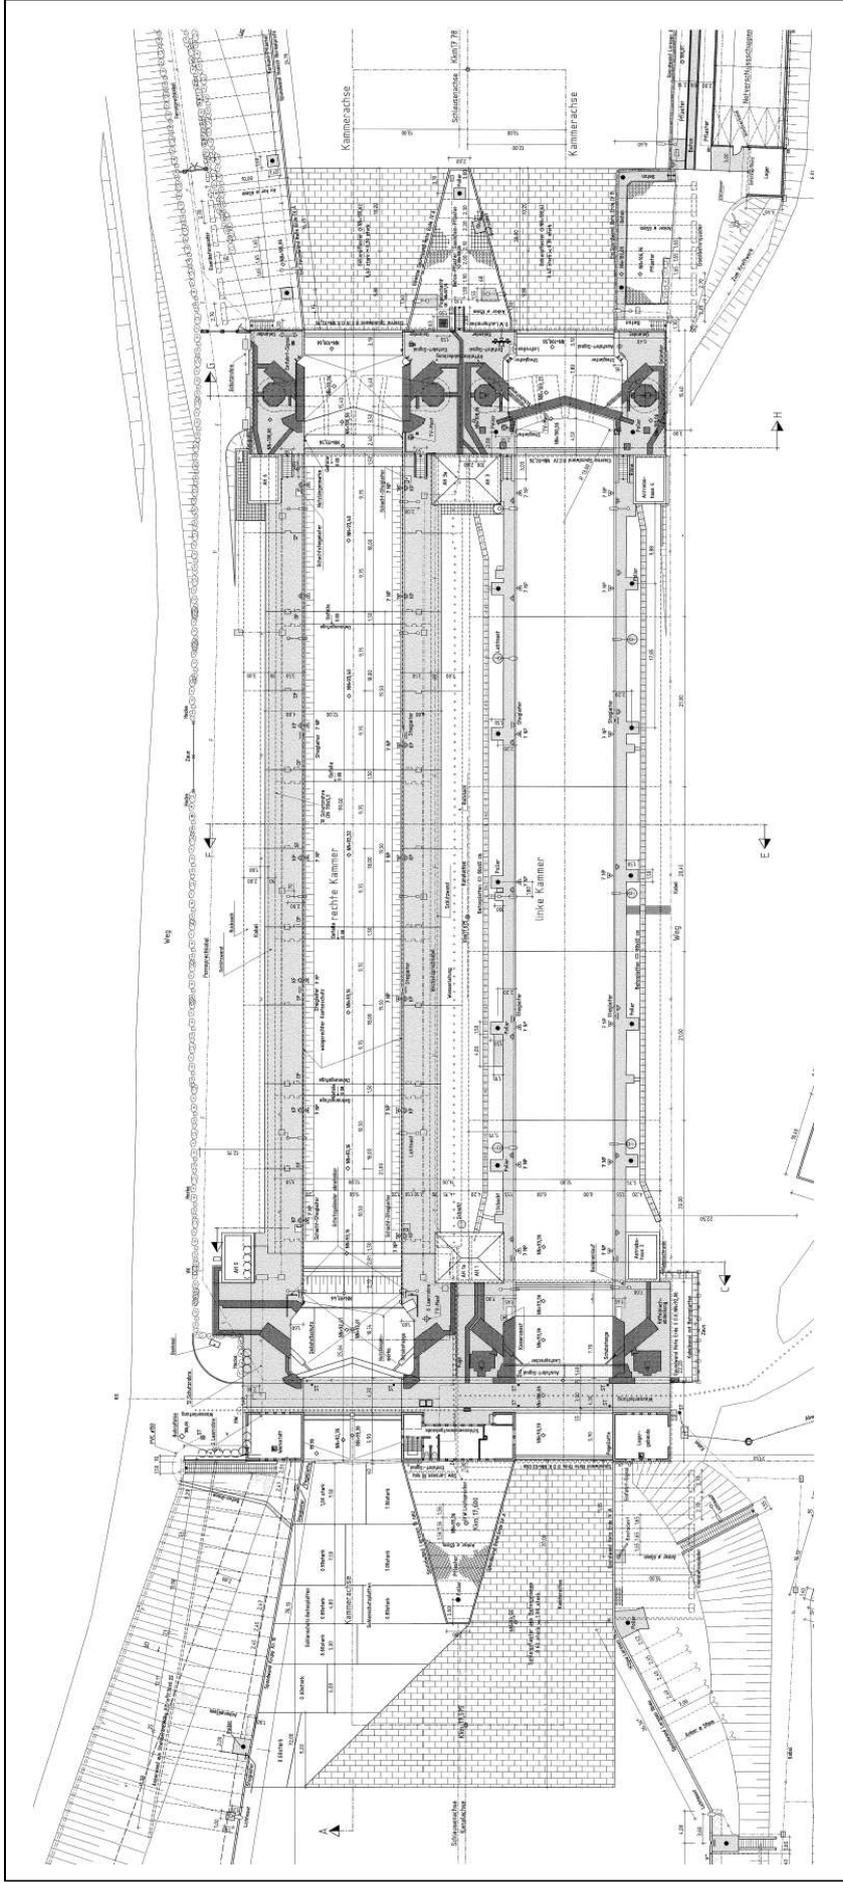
Grundriss der Schleusenanlage Schwabenheim (aus ANH 2008)
